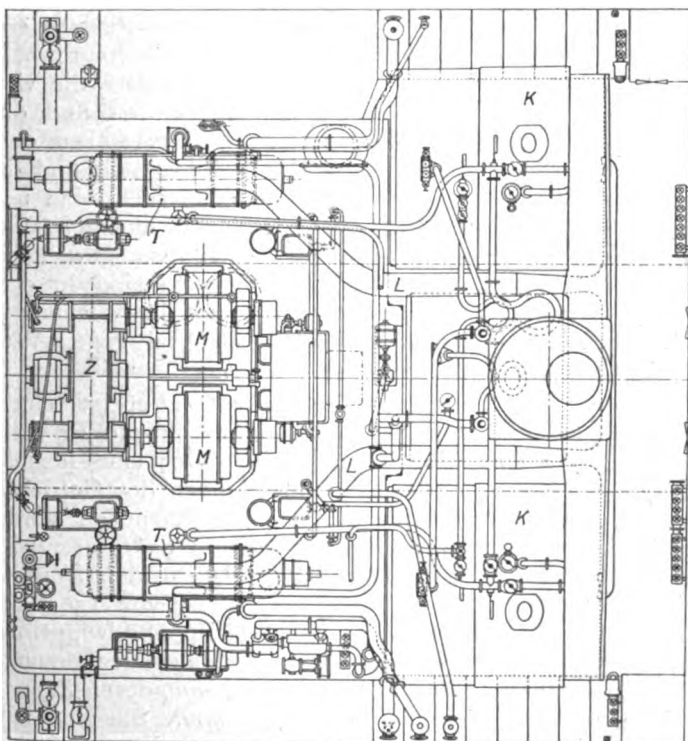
Grundriss des Maschinenraums. — 1:150.
